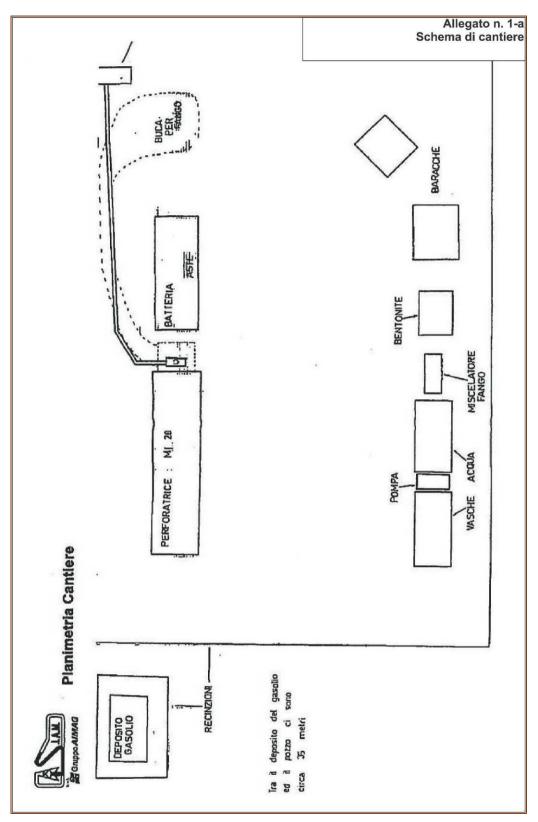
Schema Cantiere tipo di perforazione di un pozzo.
